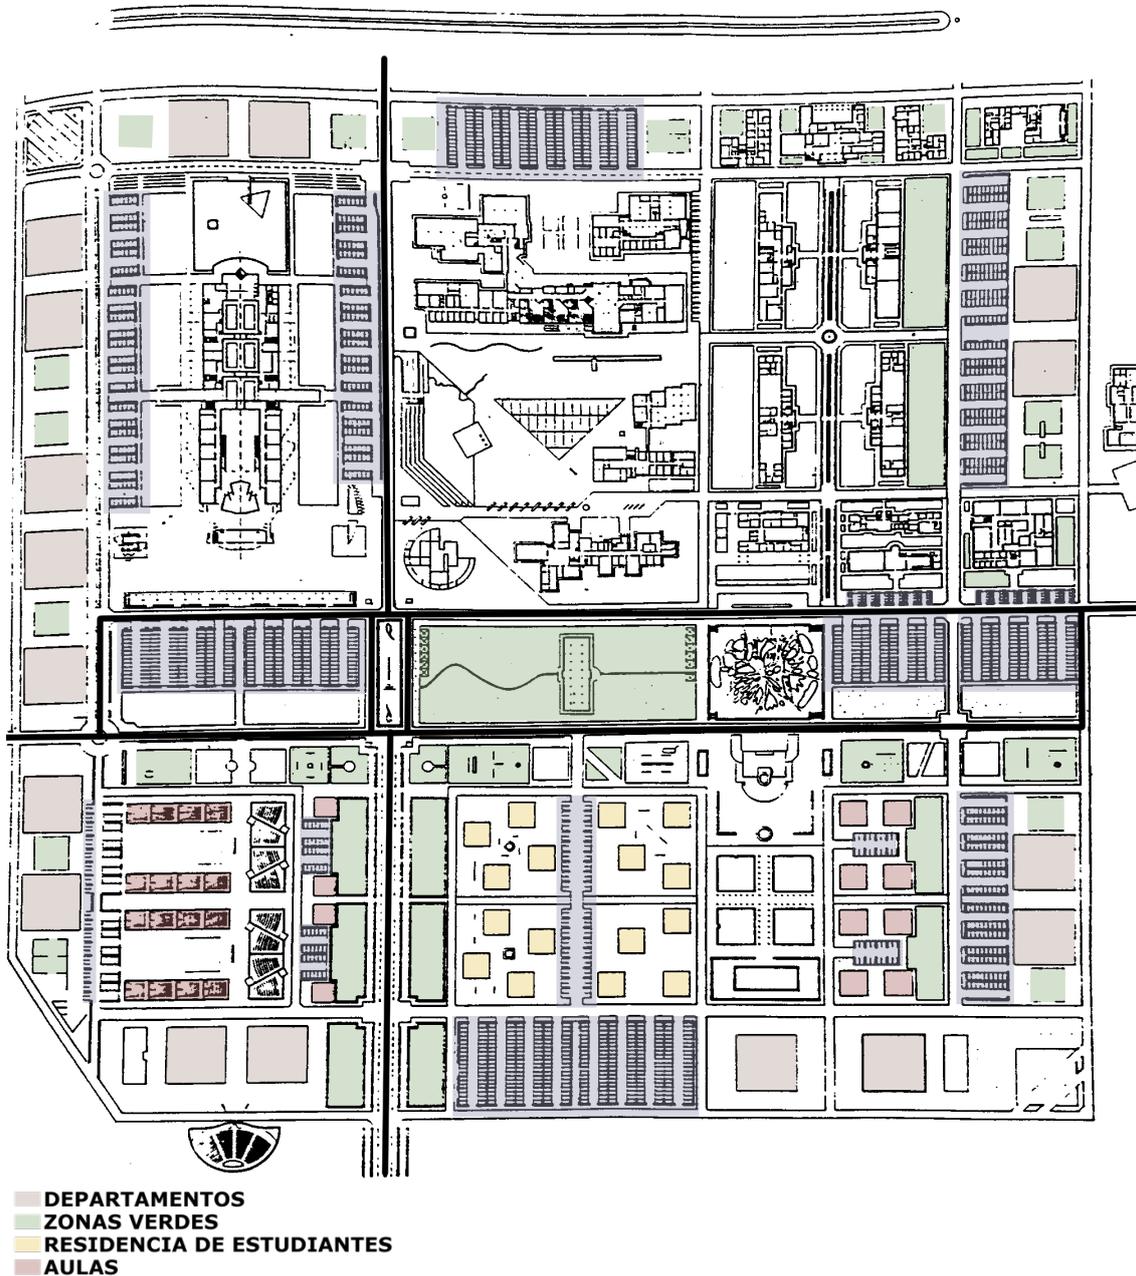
Planimetría Plan Proyecto del Campus de Alicante: E. Giménez.
